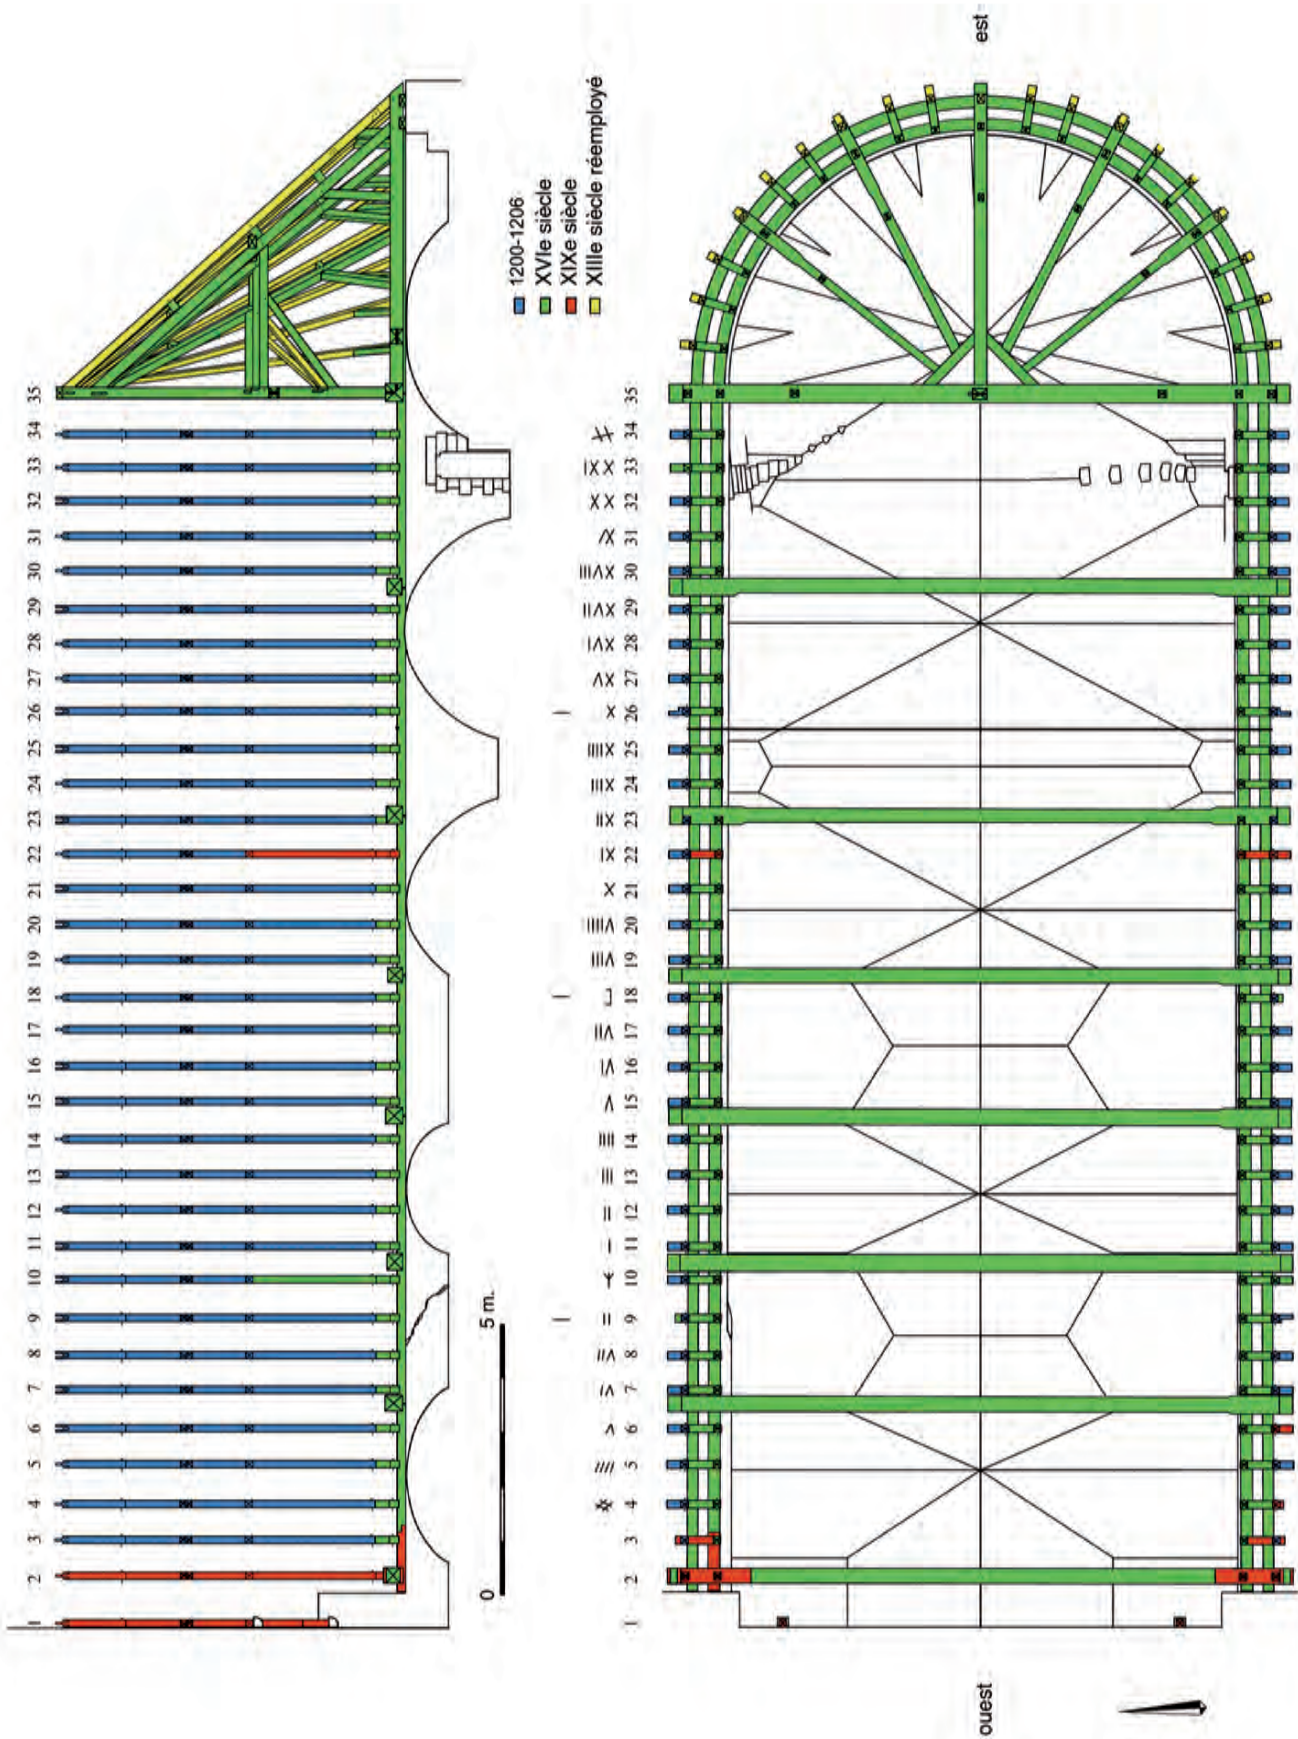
Charpente du chœur (1200-1206d) : coupe longitudinale ouest-est et plan au niveau des entrails.
